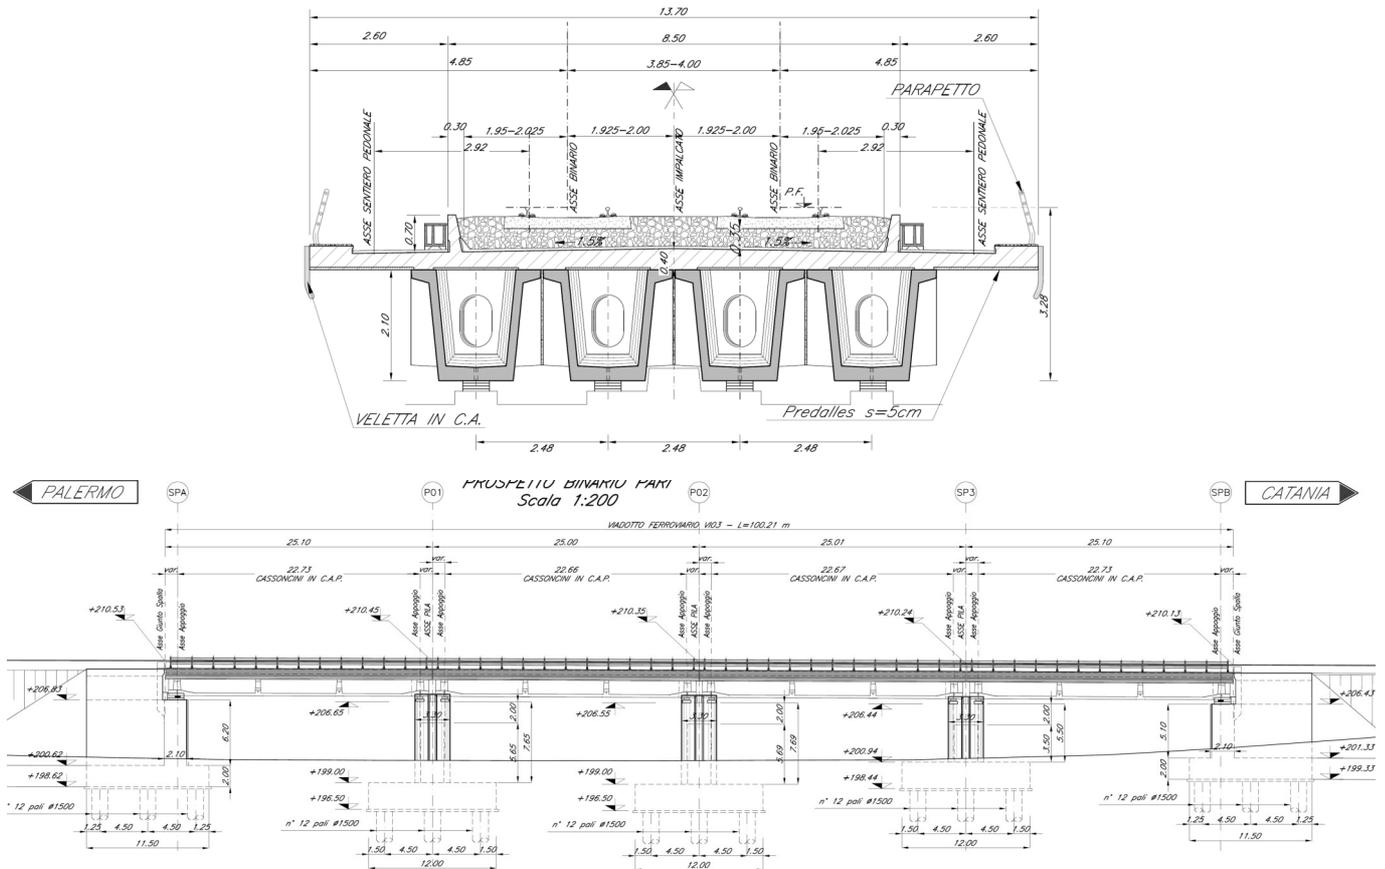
Viadotto VIII1: sezione trasversale e prospettiva binario pari
